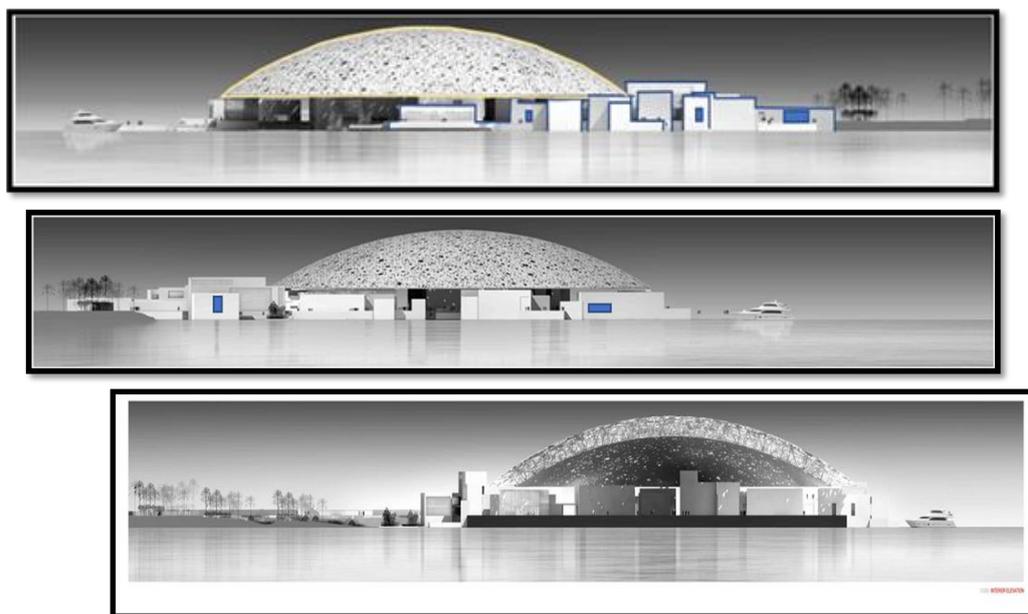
Les façades du Louvre Abu Dhabi (<https://www.archdaily.com>).
